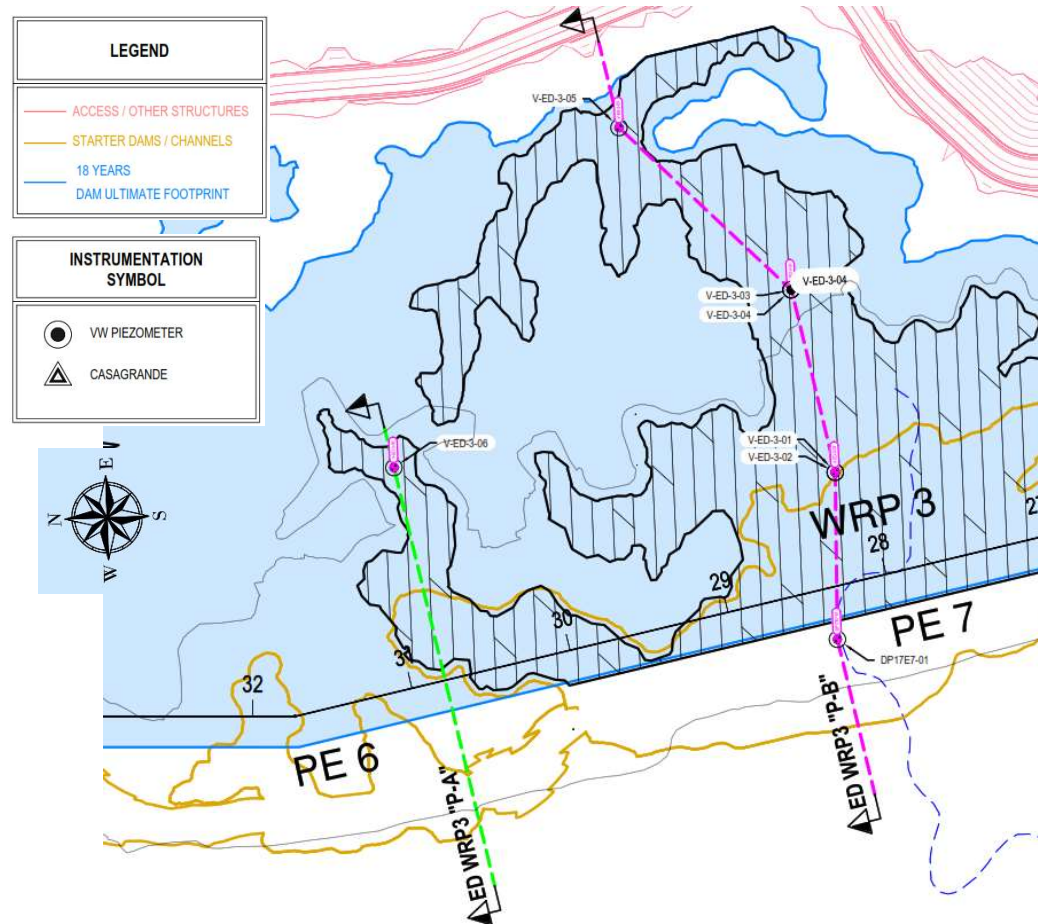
1: Vista en planta de PE WRP3 - Grupos de instrumentos Piezometro y Casagrande
